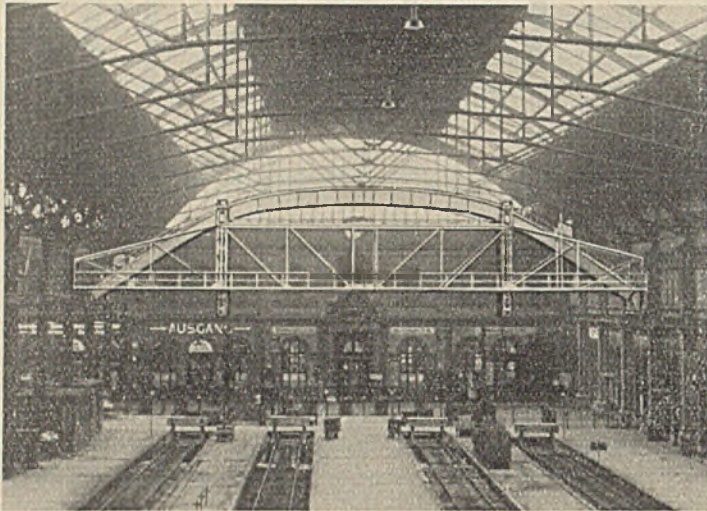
Fahrbares Besichtigungsgerüst im Hauptbahnhof München (Ruhestellung).
